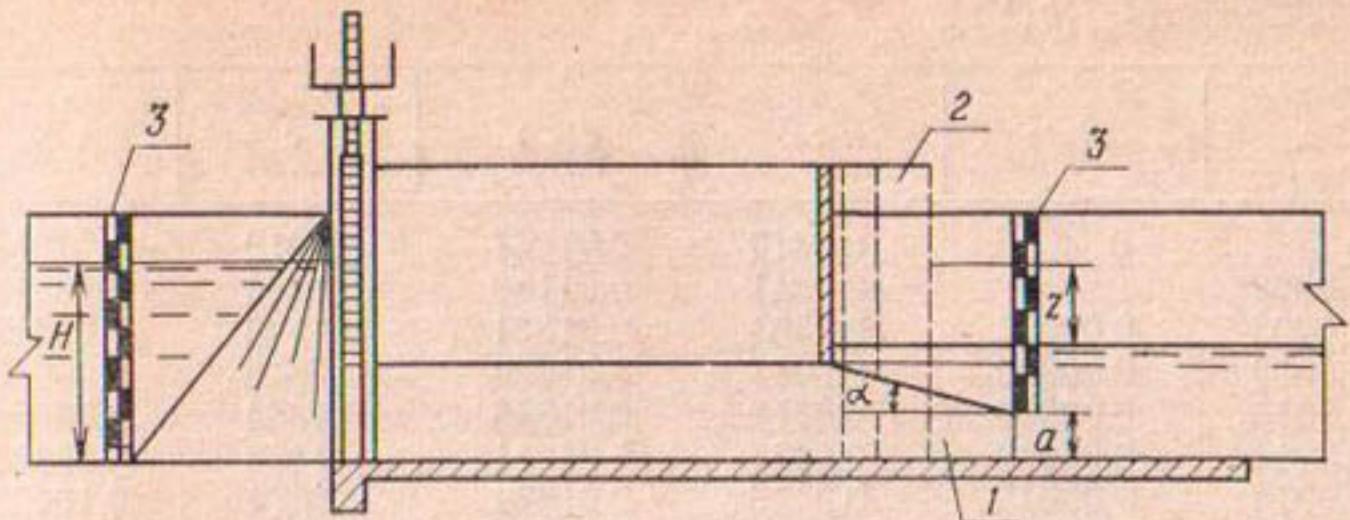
Схема сужающего устройства для трубчатых сооружений:
